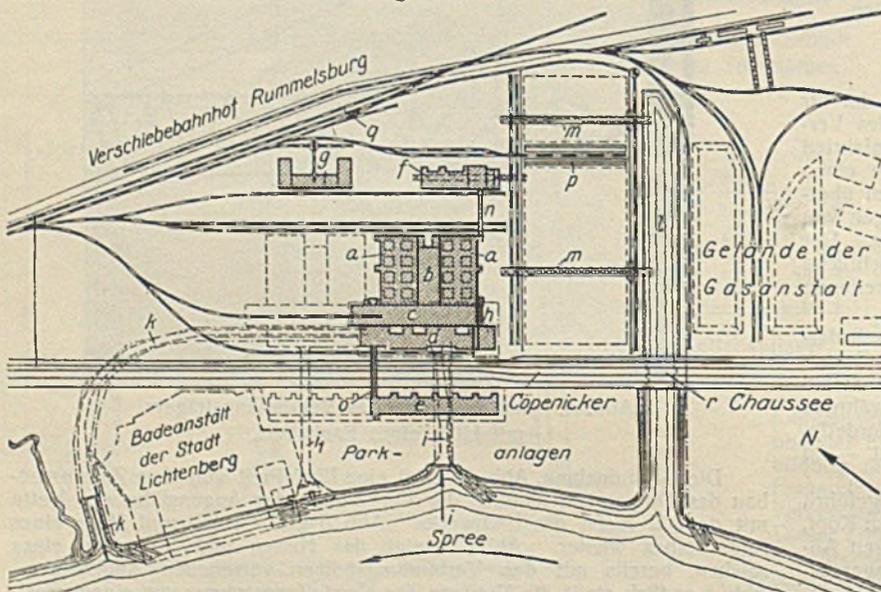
Kohlenmahlanlage, Kessel-, Maschinenhaus nebst Vorbau und Schallhaus.
